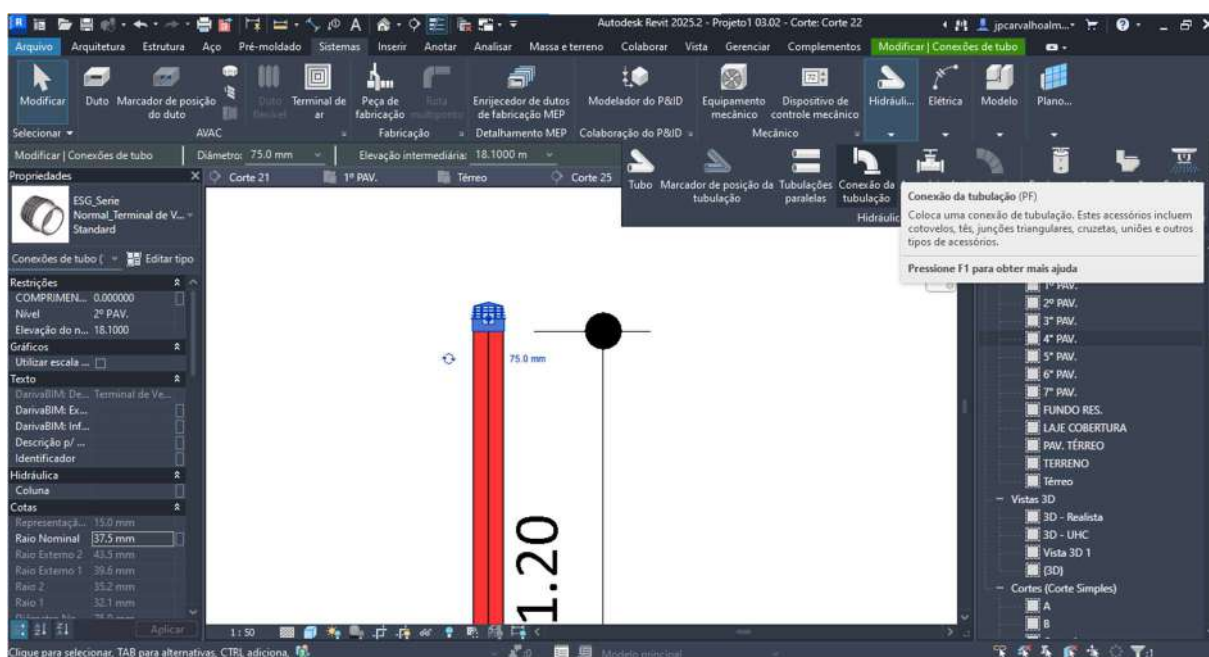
Finalizando a coluna de ventilação acima do telhado
